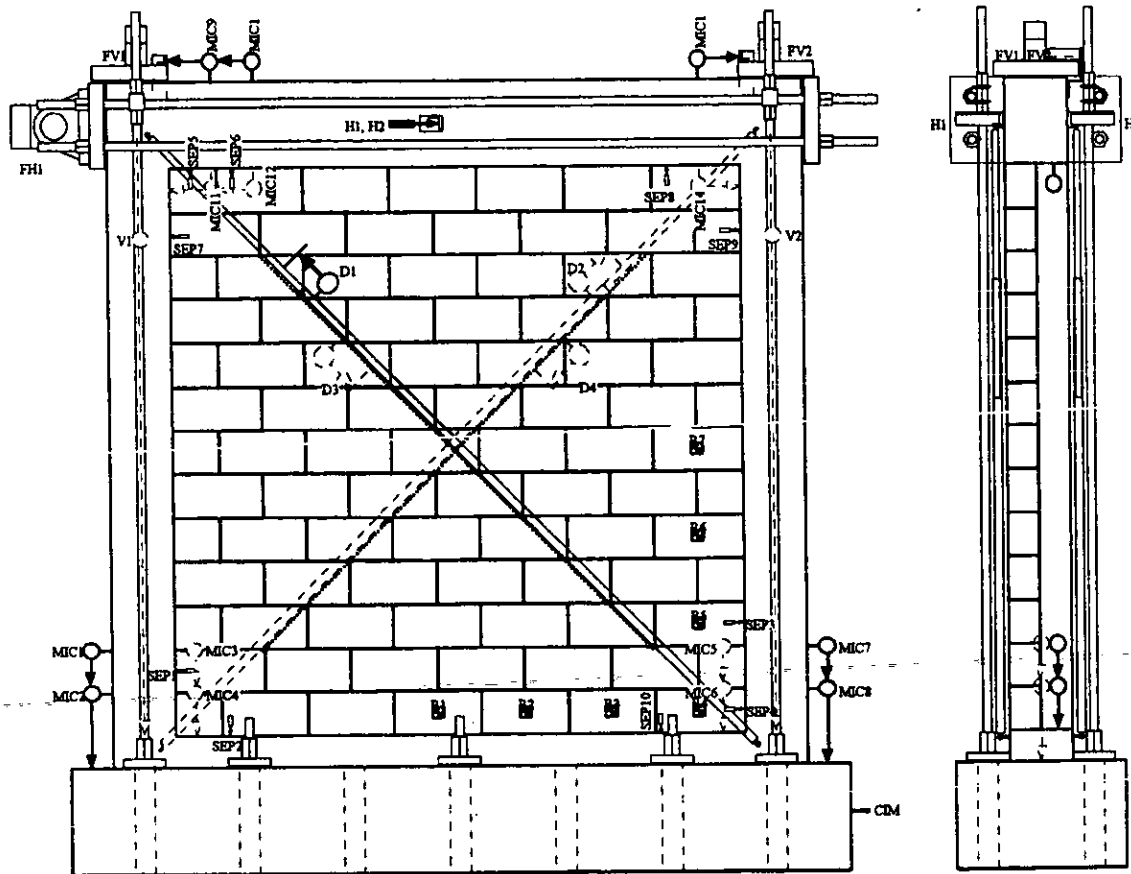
Instrumentación externa del modelo TO, cara norte
